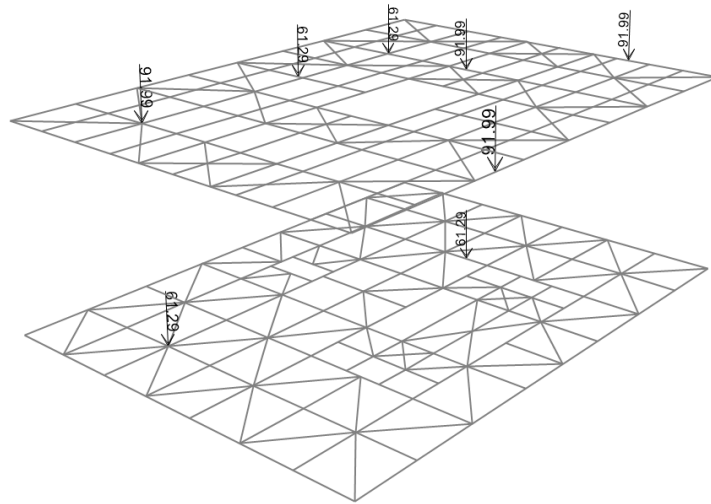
Carga de Levante Viga Monorriel (M_R).
